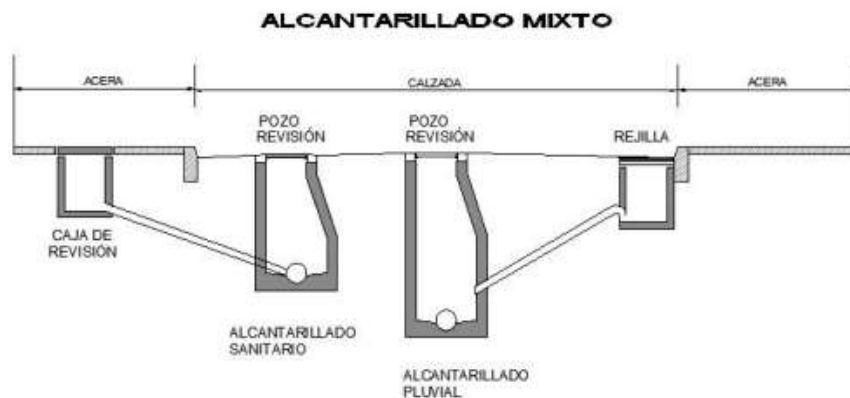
Esquema fundamental de un alcantarillado Mixto
